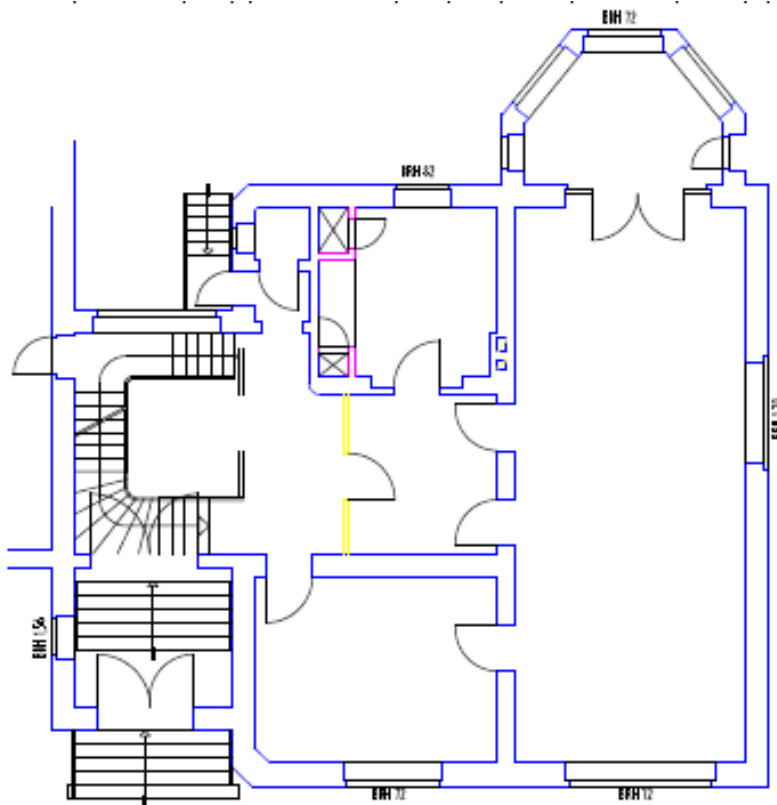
Grundrissplan EG, Gebäude HE
